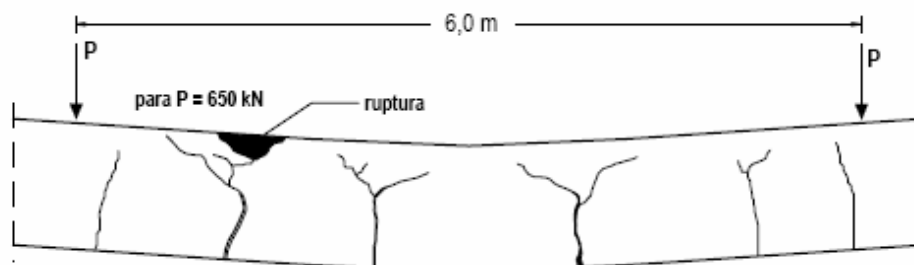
VIGA DE CONCRETO COM PROTENSÃO NÃO ADERENTE, SUJEITA A UM CARREGAMENTO
